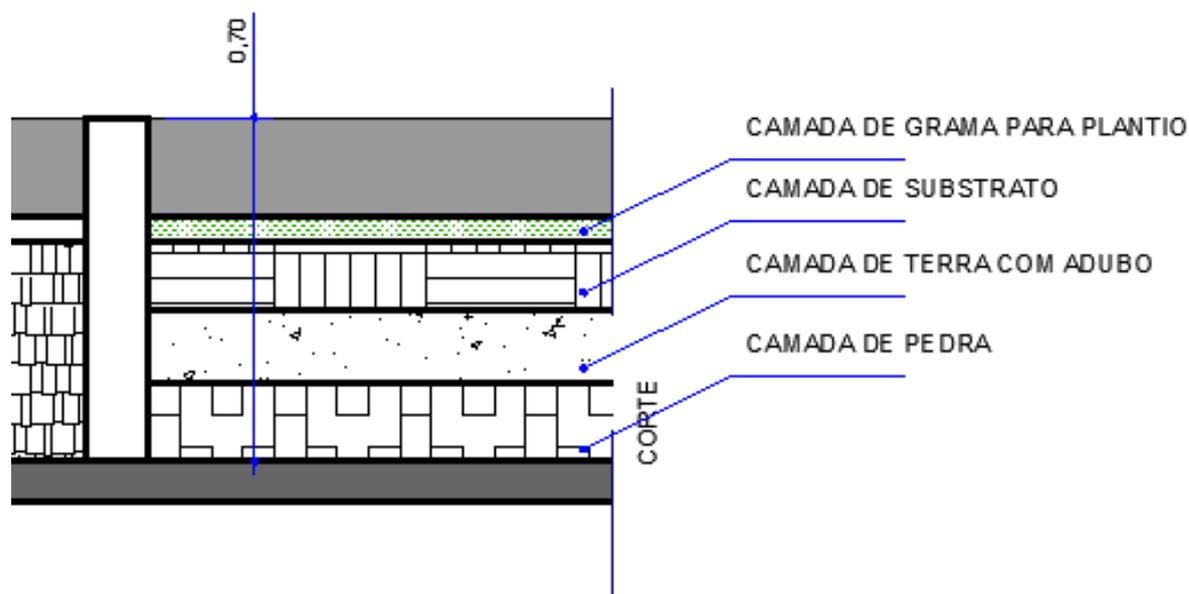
CORTE ESQUEMÁTICO JARDIM VERTICAL, PREENCHIMENTO DE CAMADAS INTERNAS –
